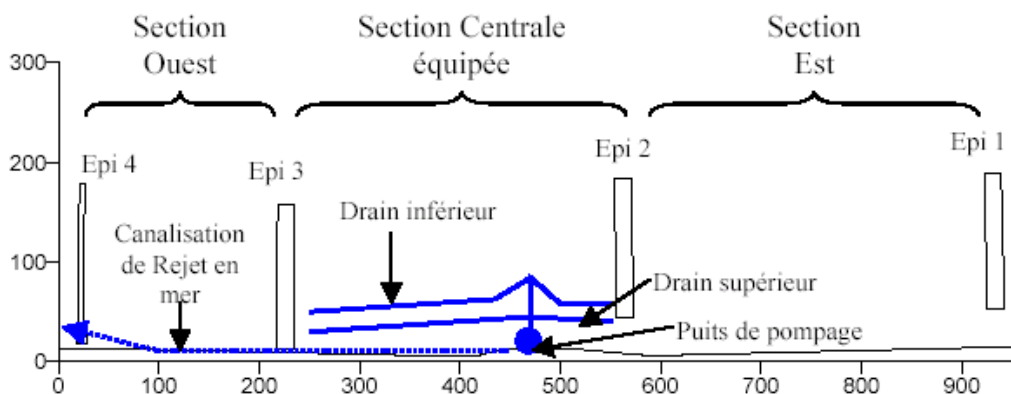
Vue en plan de l'installation du système ECOPLAGE® de Villers-sur-mer.
